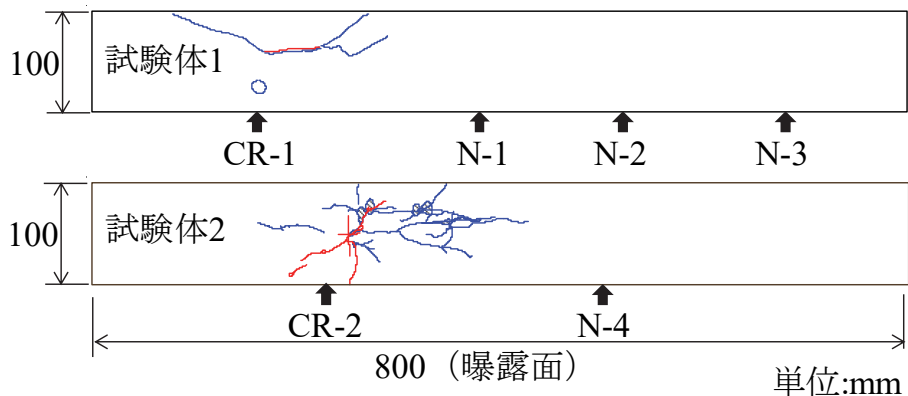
かぶり 20mm 側曝露面のひび割れ
